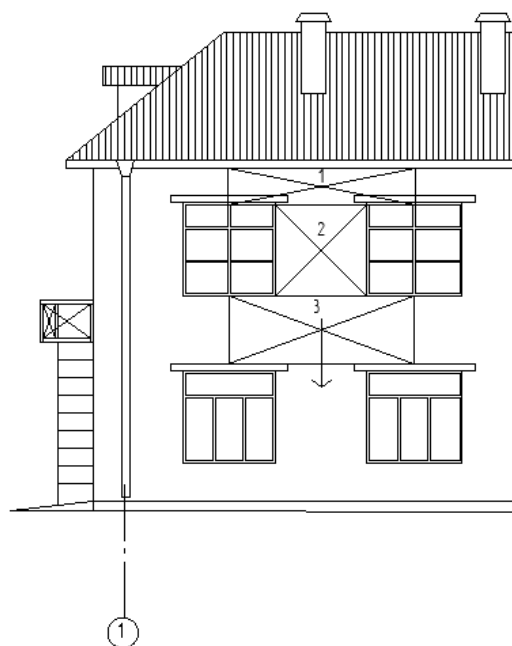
Фрагмент фасада, 1,2,3-действие нагрузок от стен на рассчитываемый простенок
